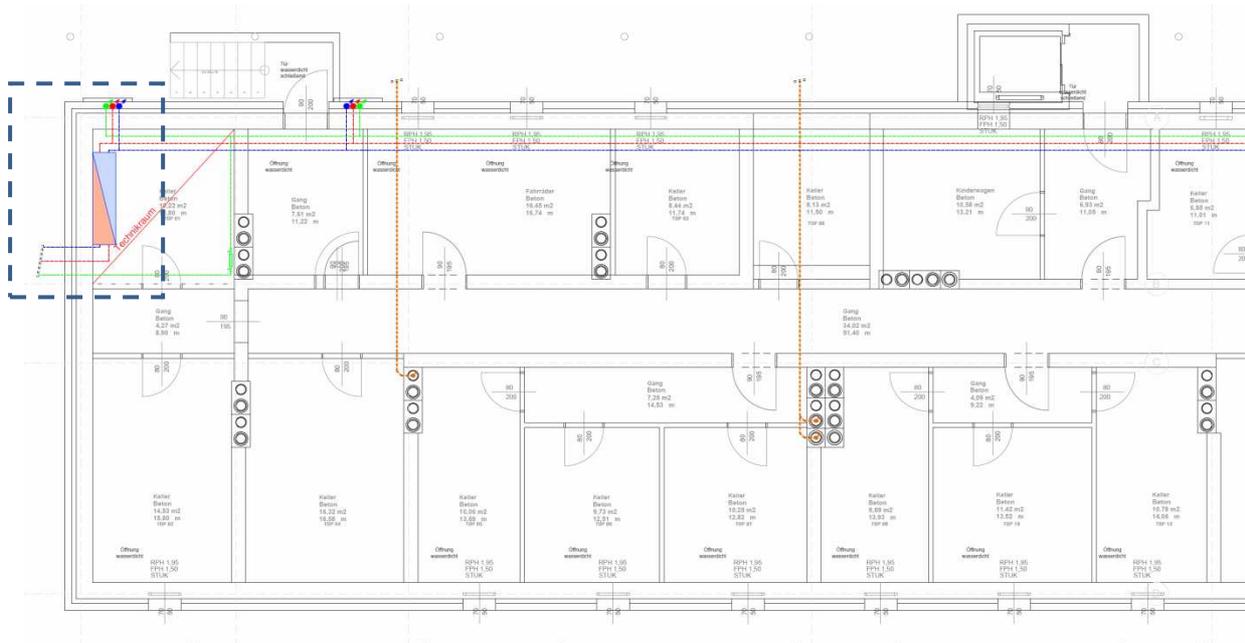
Fernwärmeanschluss im Kellergeschoß (Quelle: Technisches Büro Ing. Bernhard Hammer GmbH)
